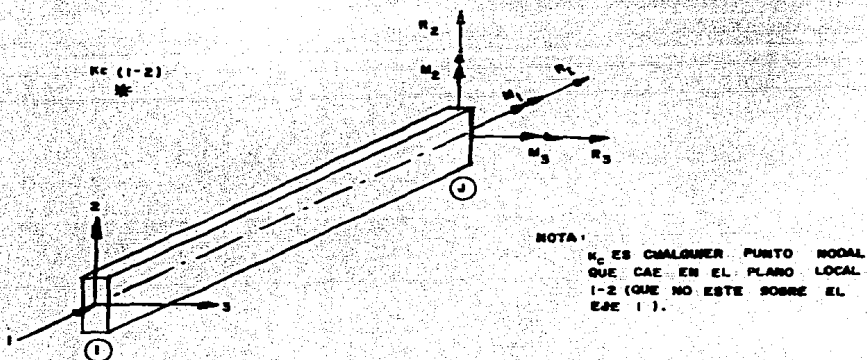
SISTEMA DE COORDENADAS LOCALES
